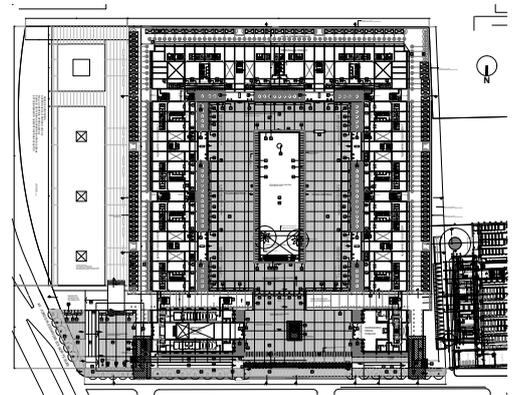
Planta primer nivel proyecto arquitectónico del CJS.
